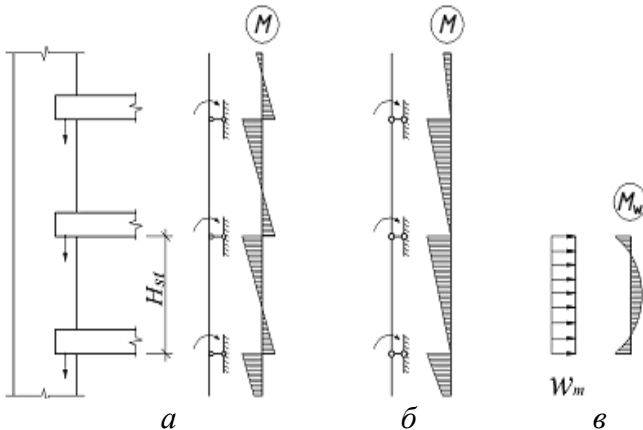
Розрахункові схеми стіни і епюри згинальних моментів від вертикальних позacentрово прикладених і горизонтальних навантажень: *a* – нерозрізна конструкція; *б* – розрізна конструкція, в межах поверху; *в* – від дії вітрового навантаження
